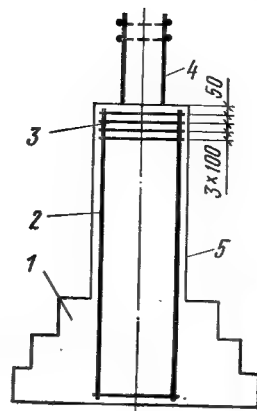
Общий вид и сопряжение монолитной колонны с фундаментом
